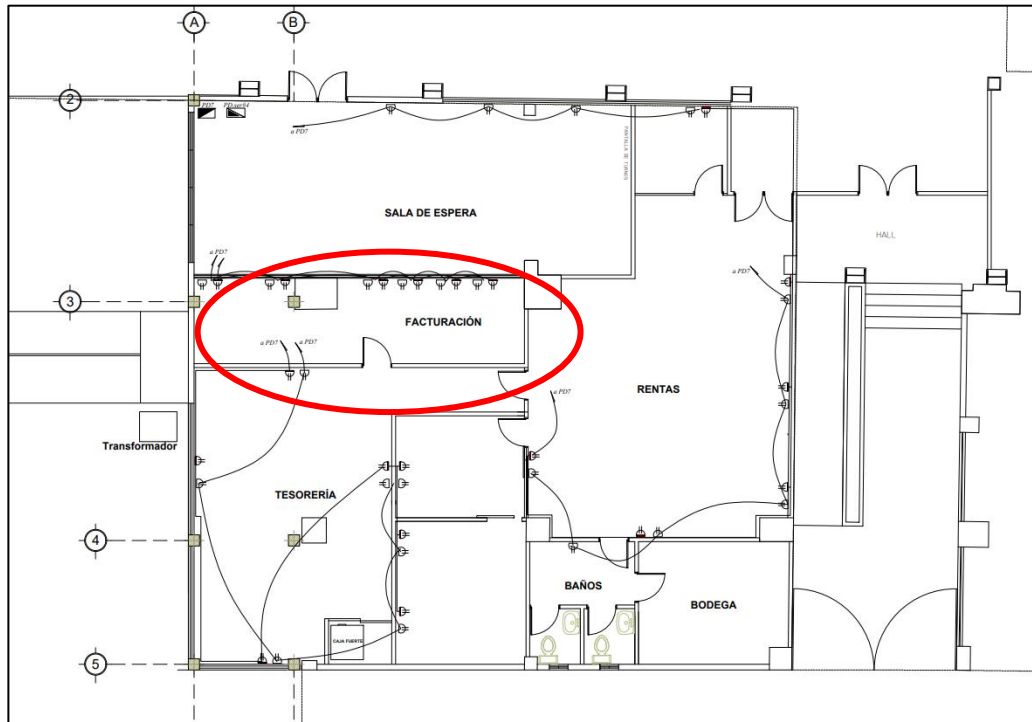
Plano de Sistema de Tomacorrientes – Planta Baja [2]
